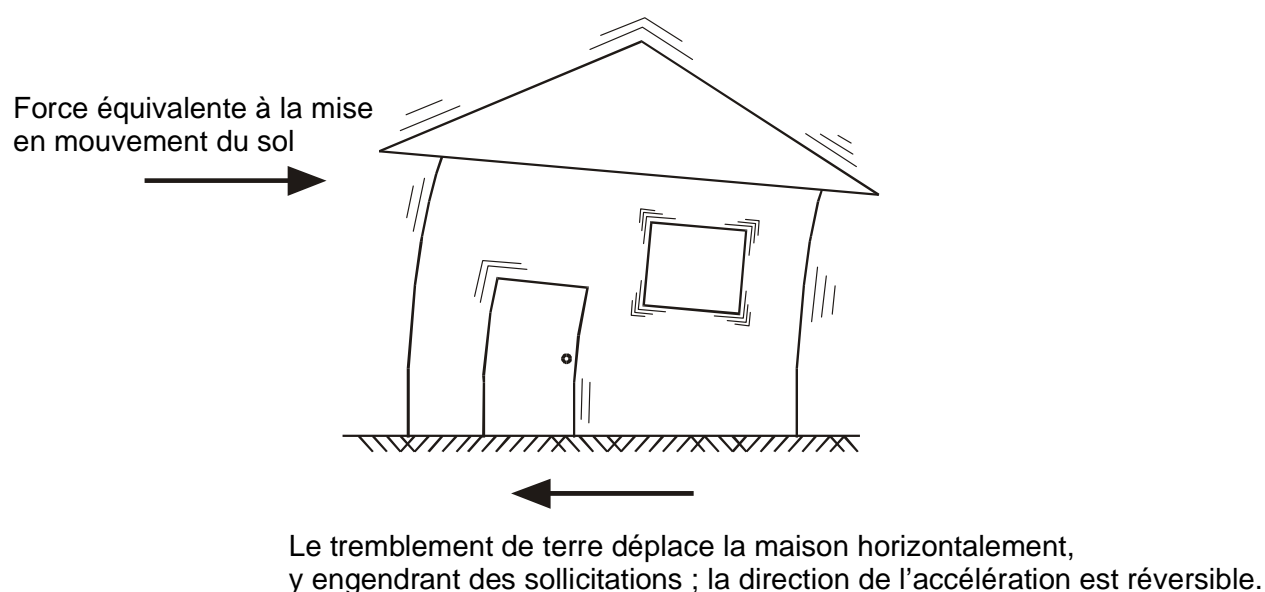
Principe d'action d'un tremblement de terre sur une structure
